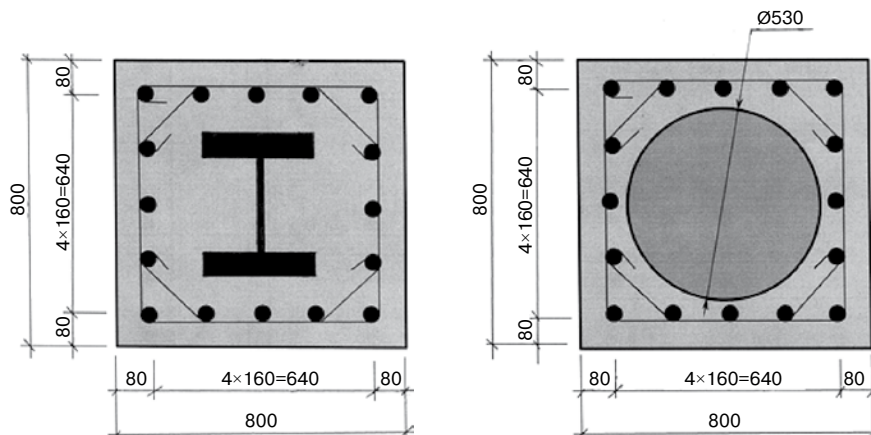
Поперечное сечение ЖБ колонны сечением 0,8×0,8 с жесткой арматурой (а) и ТЖБ колонны (б)
